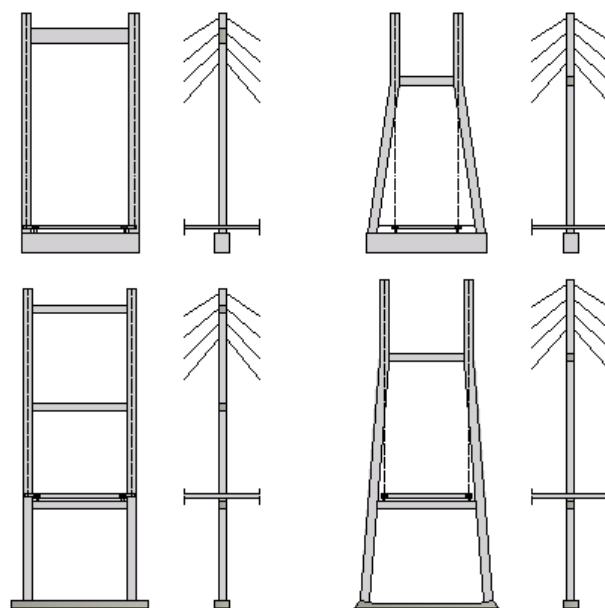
Configuração geométrica das torres, configuração em pórtico (adaptado [8]).
